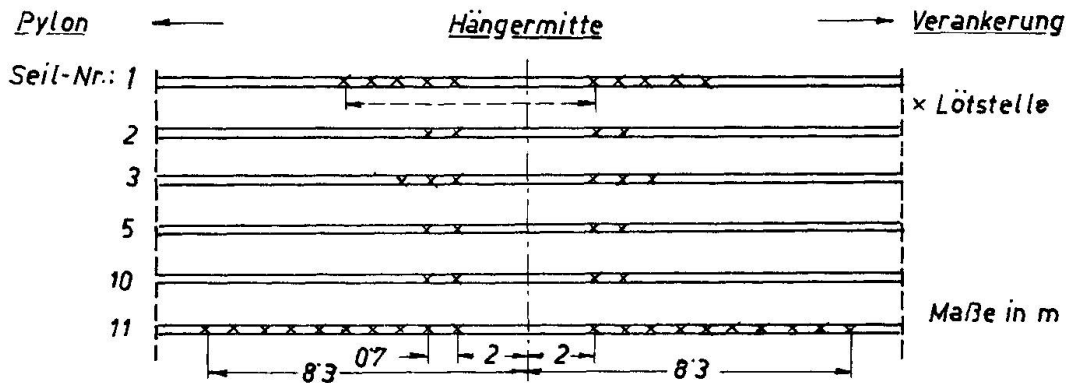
Lötstellenplan zur Sanierung der verschlossenen Tragseile im Bereich einer Hängerklemme
